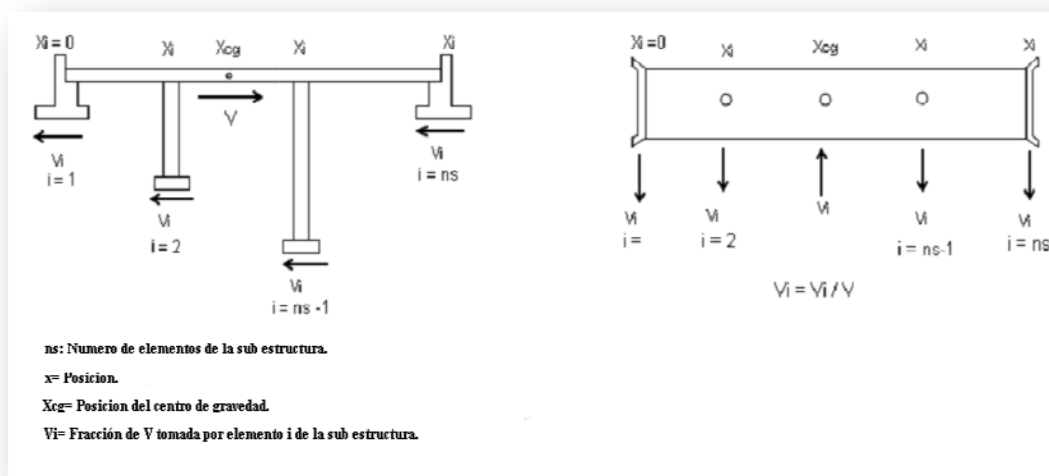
Distribución de fuerza en la dirección longitudinal y transversal.
